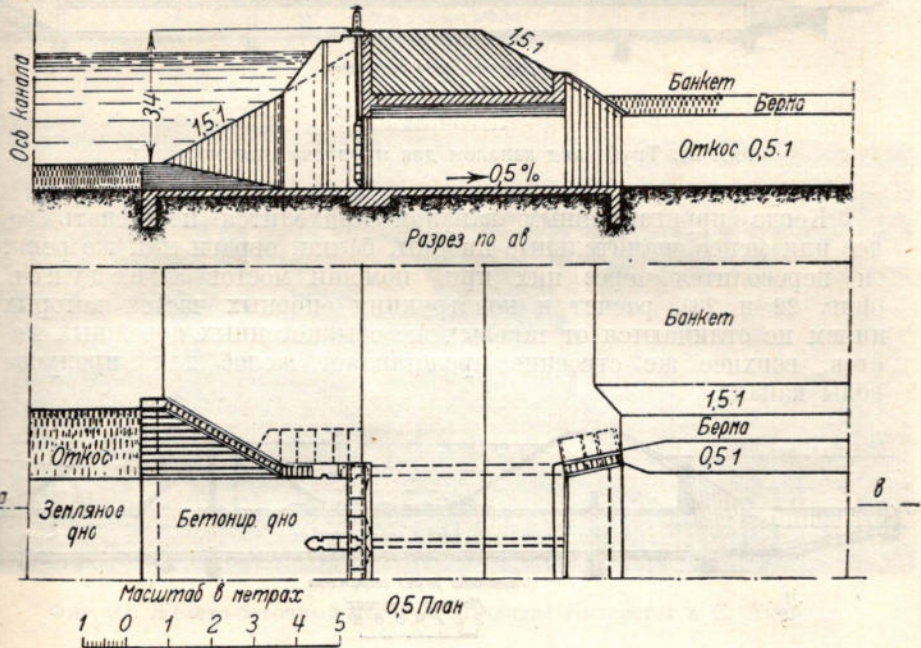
Поперечное сечение оросительного канала в насыпи.
